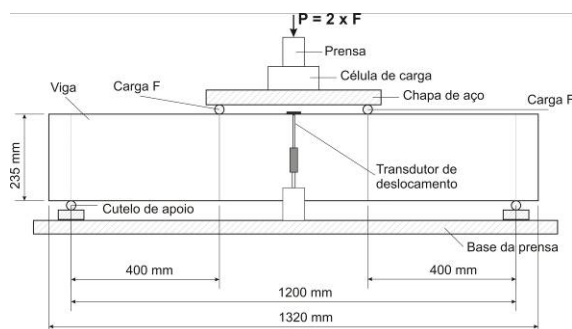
Ilustração do ensaio de flexão das vigas de concreto armado.
